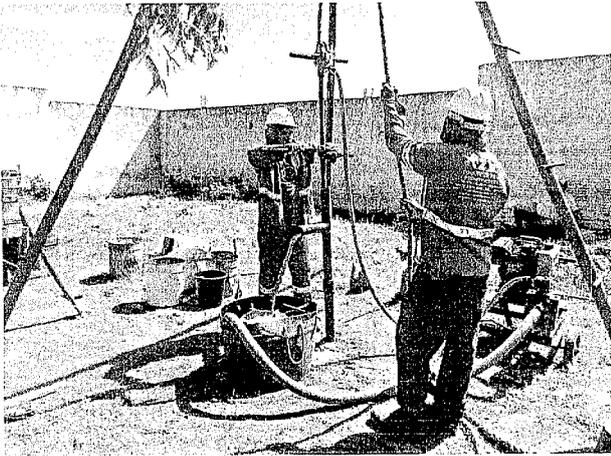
Detalhe da operação de lavagem para atingir a cota de amostragem do furo de sondagem.
